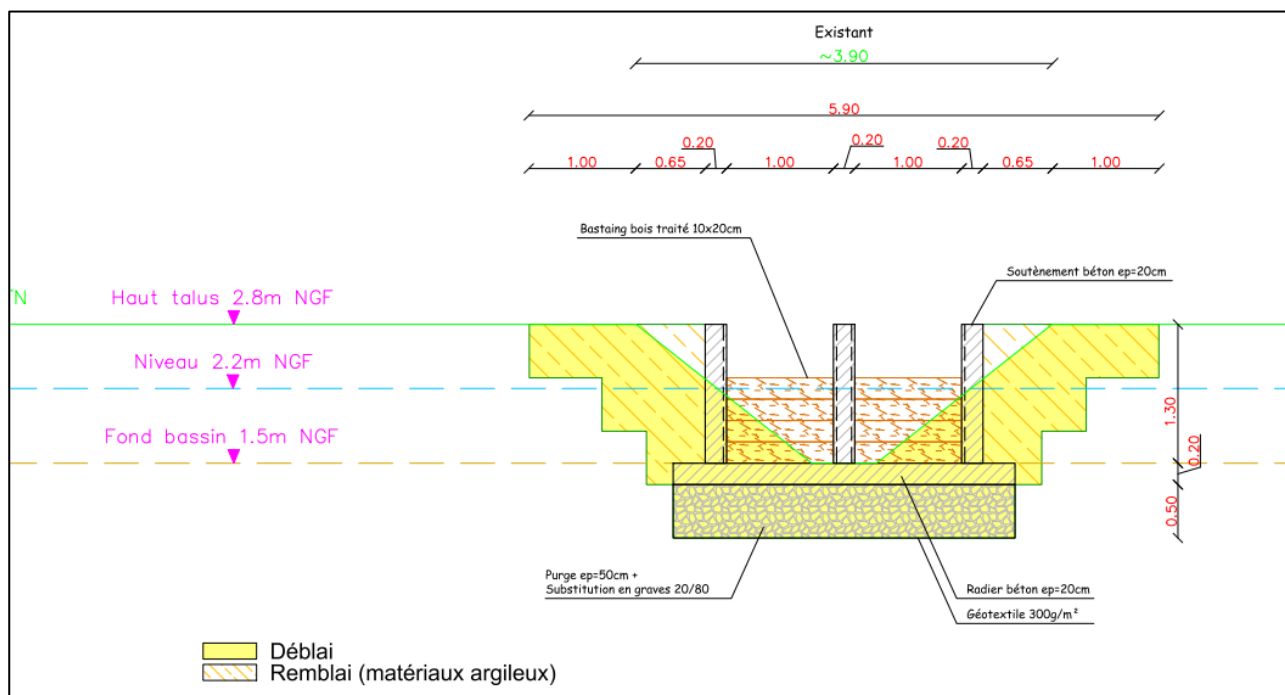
Extrait de la coupe vue de face de l'ouvrage n°201
